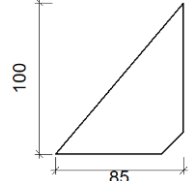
Detalle placa de anclaje tipo 6. Fuente: CYPE 3D.
